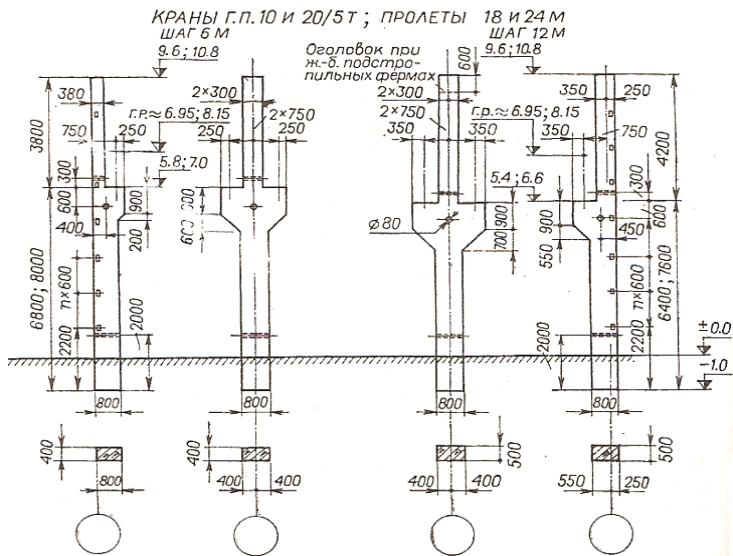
Типы сплошных железобетонных колонн для зданий с мостовыми опорными кранами
